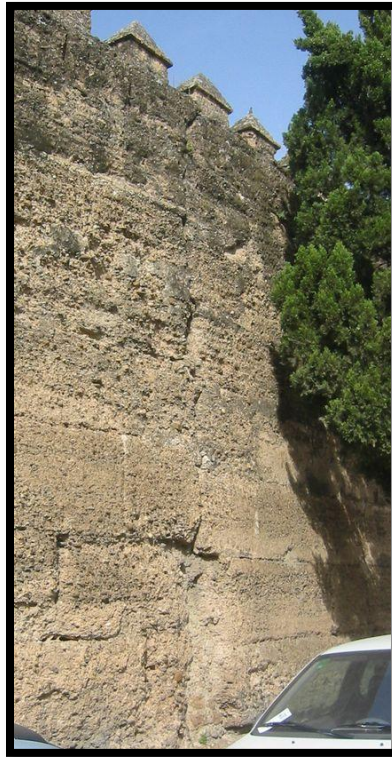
Muralla afectada por acción de grietas.
